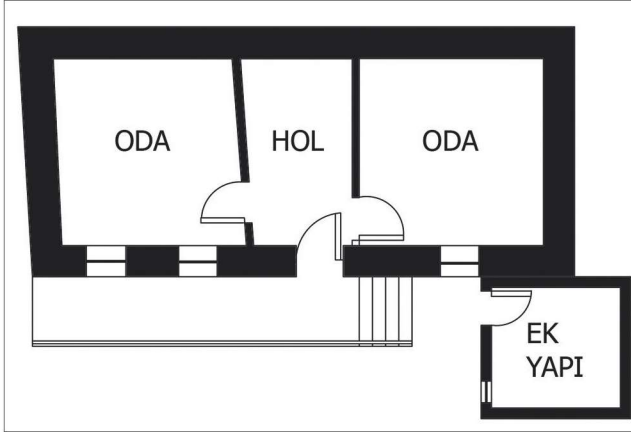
968 Parsel, Zemin Kat Planı / Building lot: 968, ground floor plan
